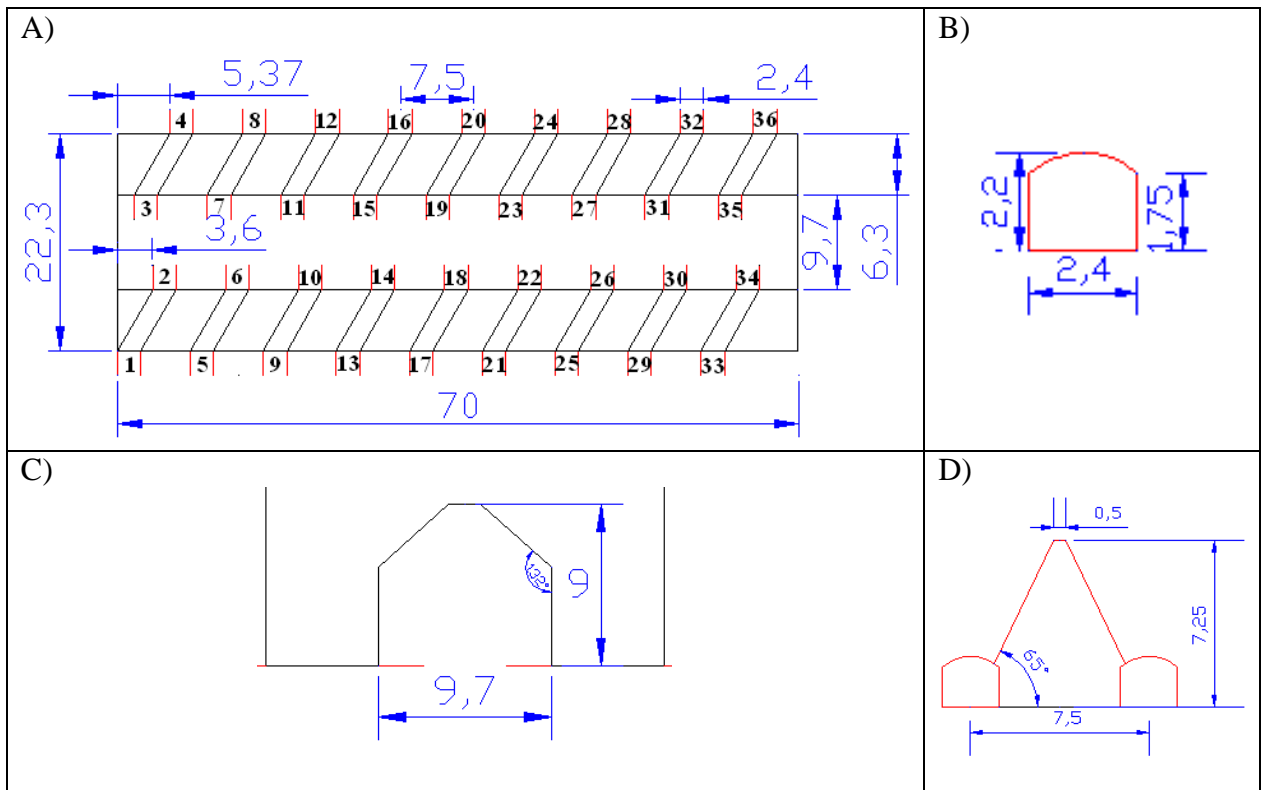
Base del modelo físico. Cotas en [cm]. A) Vista en planta y puntos de extracción. B) Dimensiones de un punto de extracción, vista frontal. C) Pilar corona, vista en perfil. D) Pilar de zanja entre dos puntos de extracción y sus dimensiones.
